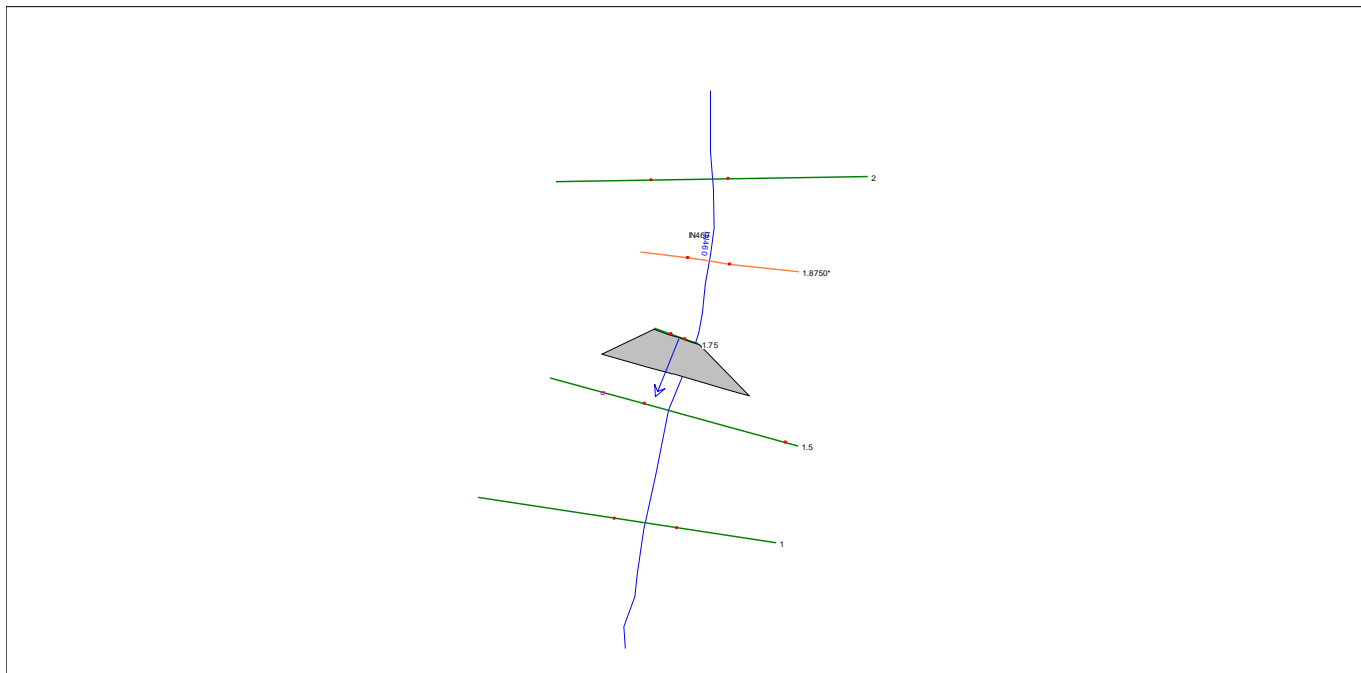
Planimetria modello 1D – stato di progetto interferenza IN460.
